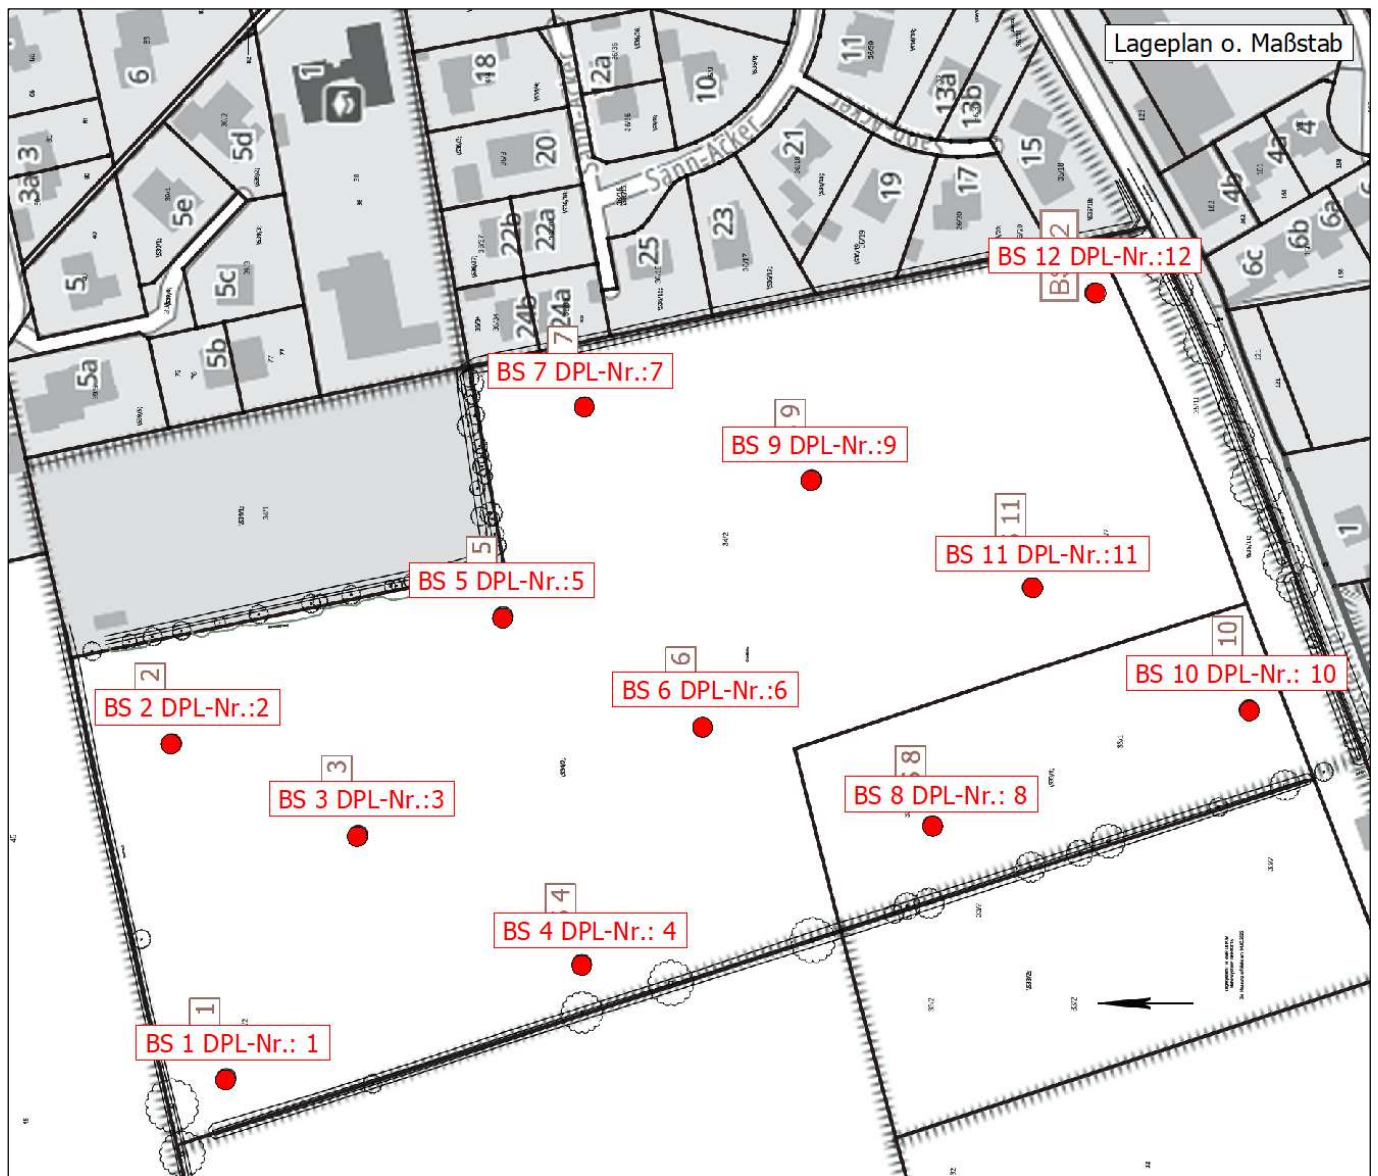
Lageplanausschnitt Anl. 1.1, (o. M.)
